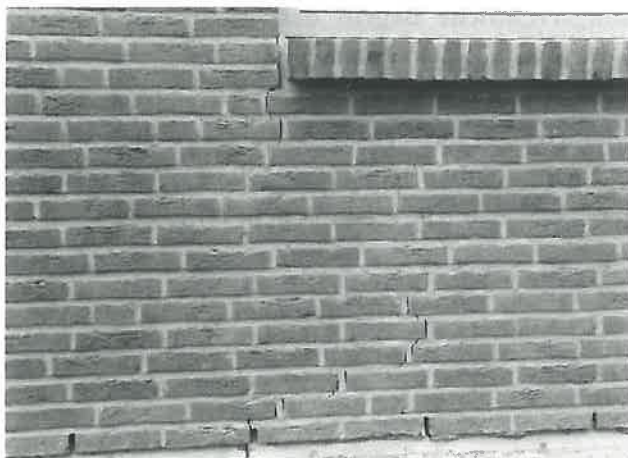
Risse im Innenmauerwerk über Balken (Pos. 40, Abb. 2) nach dem Putzen
